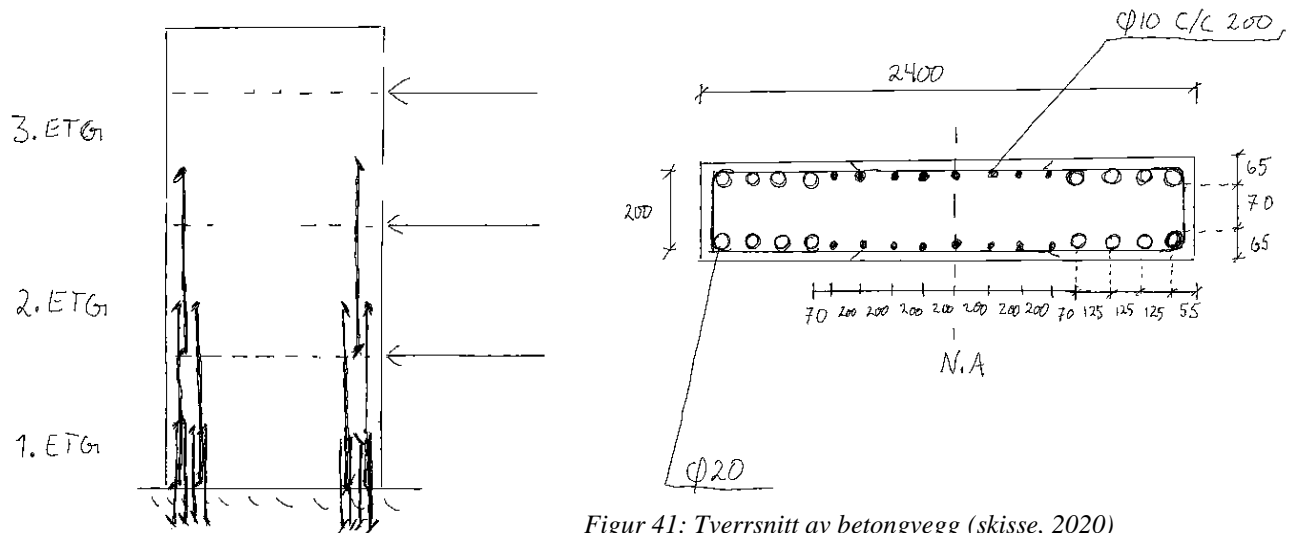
Horisontale krefter på betongvegg (skisse, 2020)
